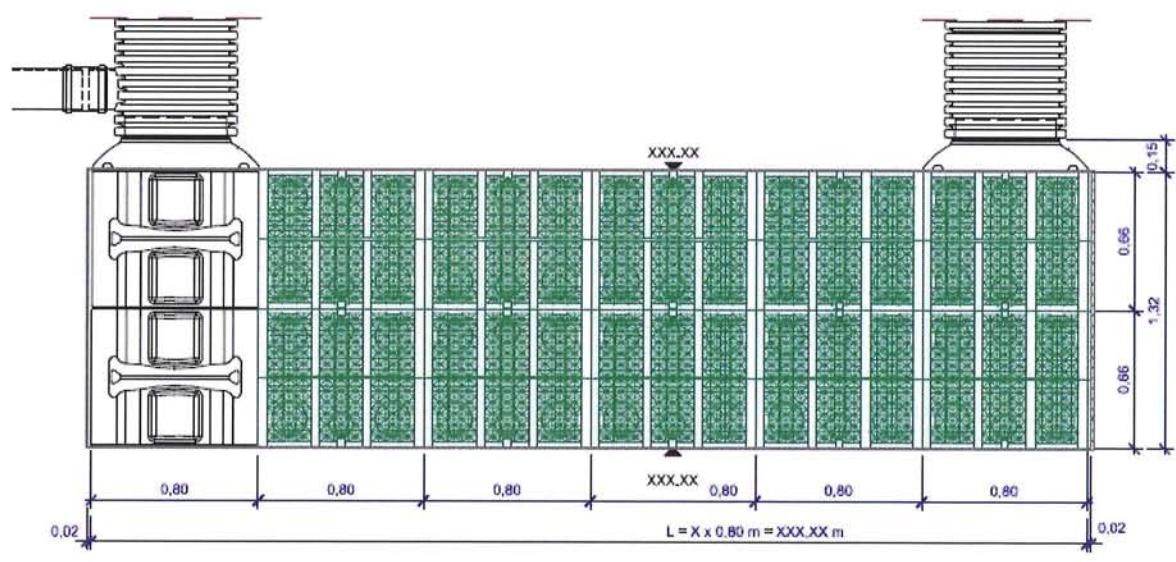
Coupe de principe d'un bassin réalisé avec RIGOFILL INSPECT et boîte d'inspection intégrée
